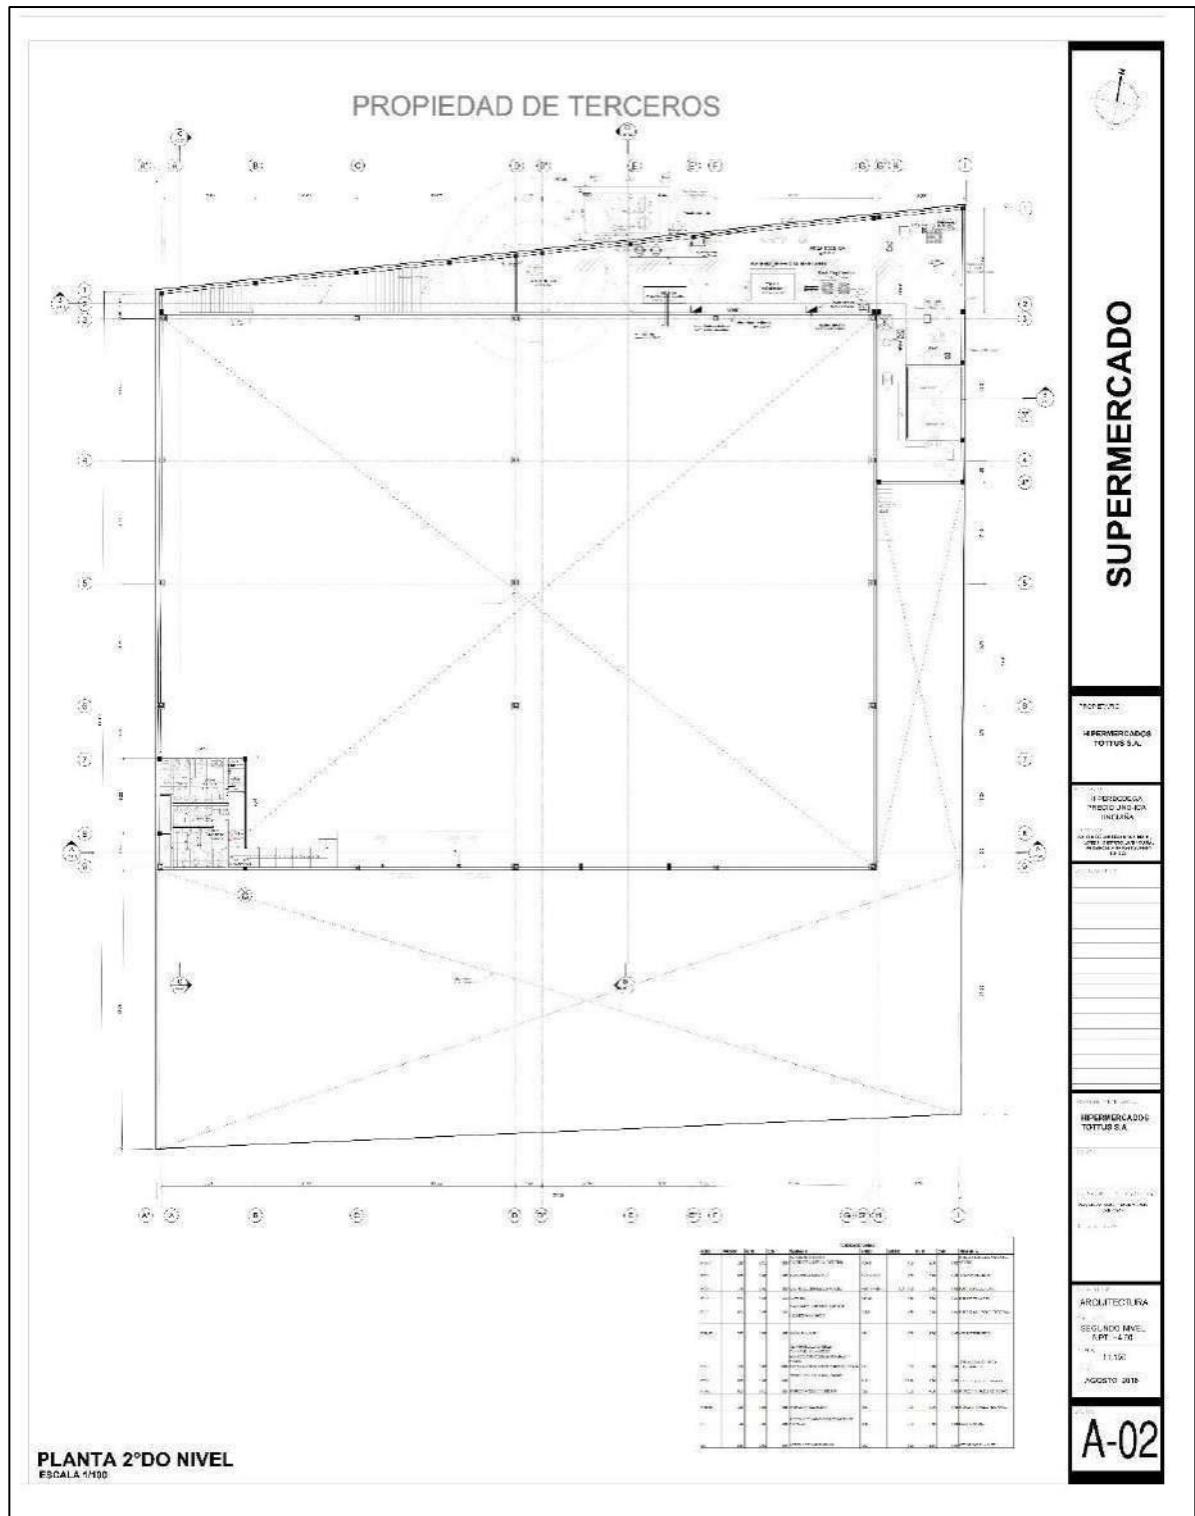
Plano Segundo Nivel- Ica Tinguiña
